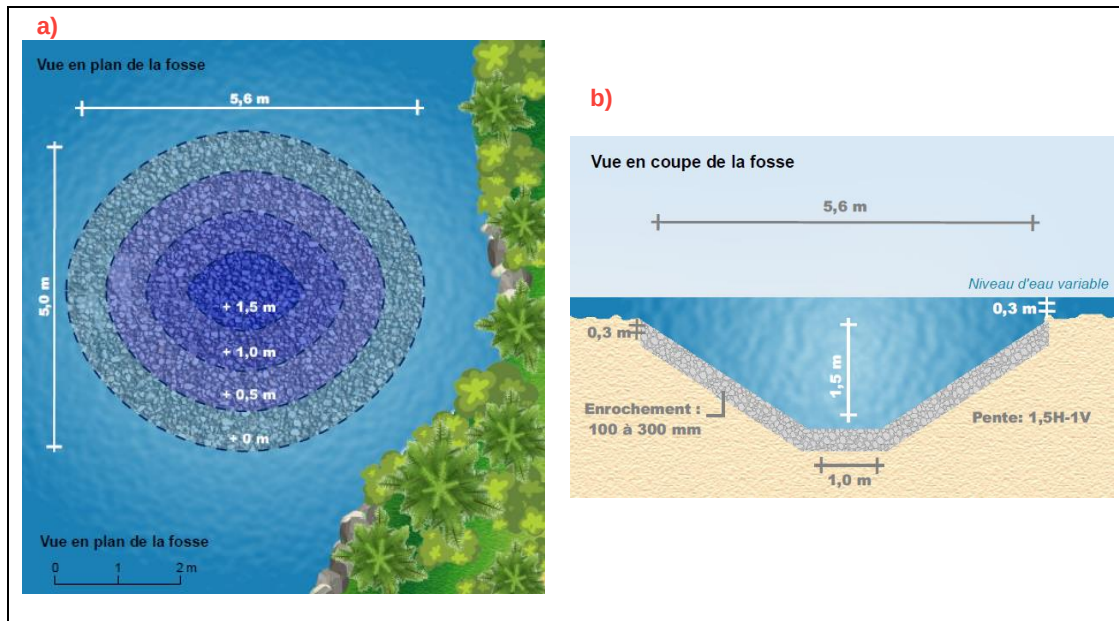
Exemple d'un aménagement de fosse : a) vue en plan; b) vue en coupe
